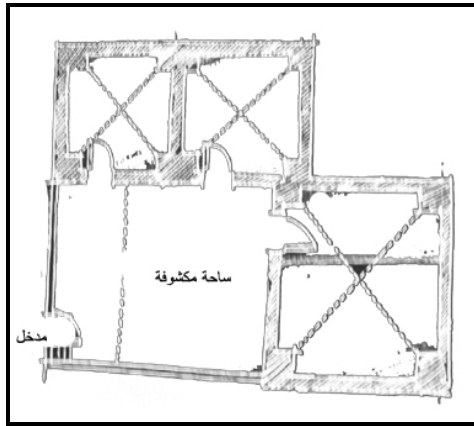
مخطط الطابق الأول لبيت ذو ساحة مكشوفة
